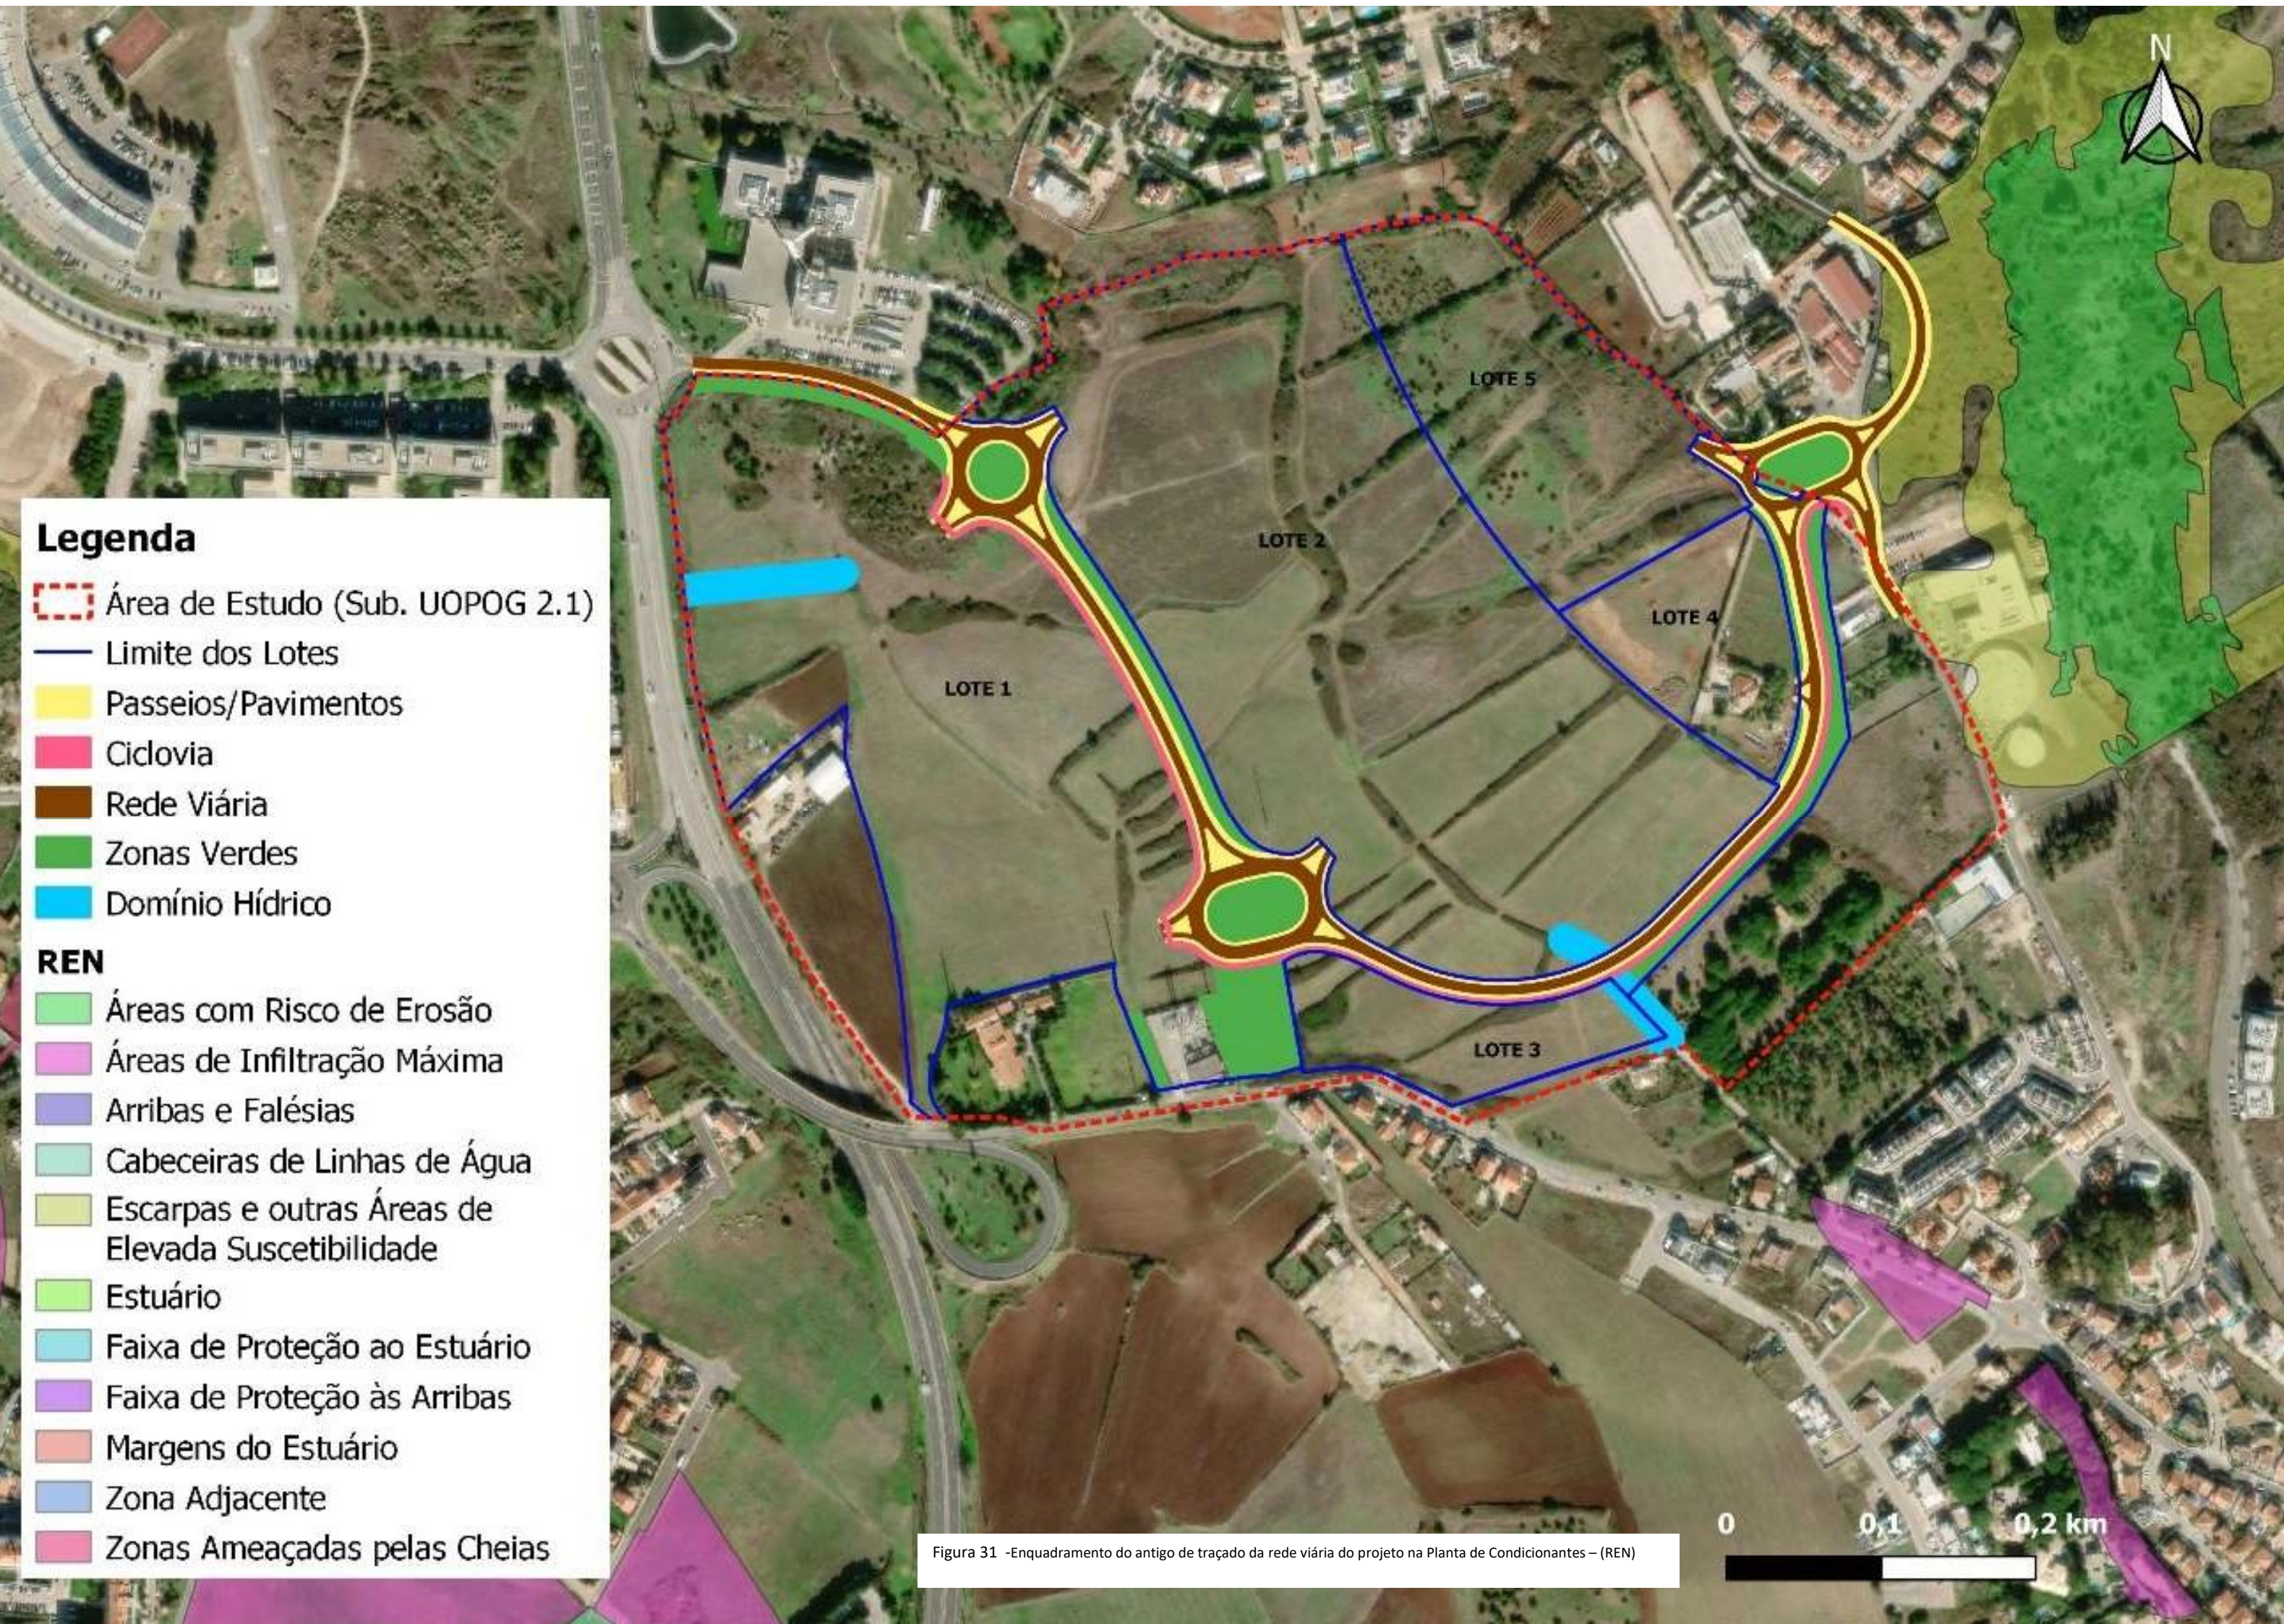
Enquadramento do antigo de traçado da rede viária do projeto na Planta de Condicionantes – (REN)
